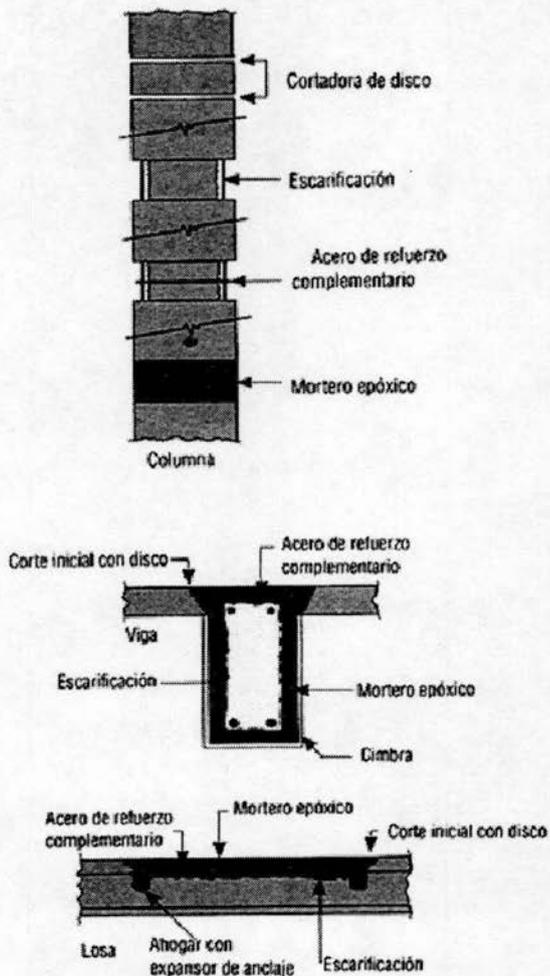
Refuerzos – Acero de refuerzo empotrado con mortero de base epóxica
